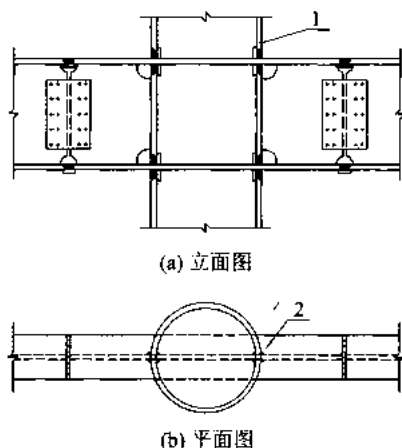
钢梁 钢管混凝土柱穿心式连接
